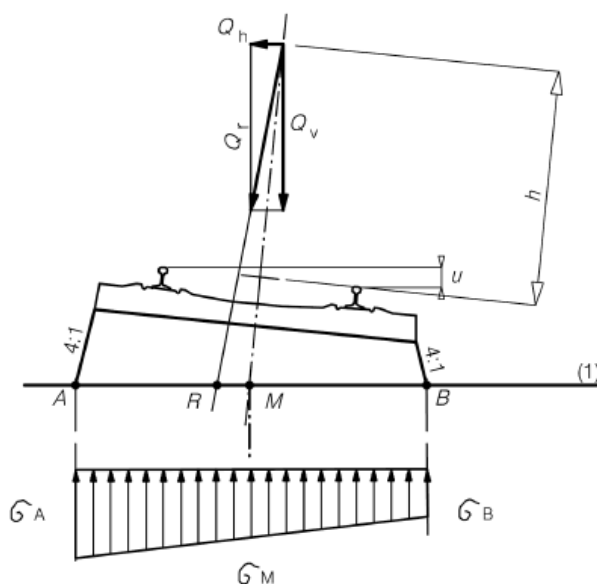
Distribuição transversal da carga pela travessa e pelo balastro num troço de via com sobreelevação.
